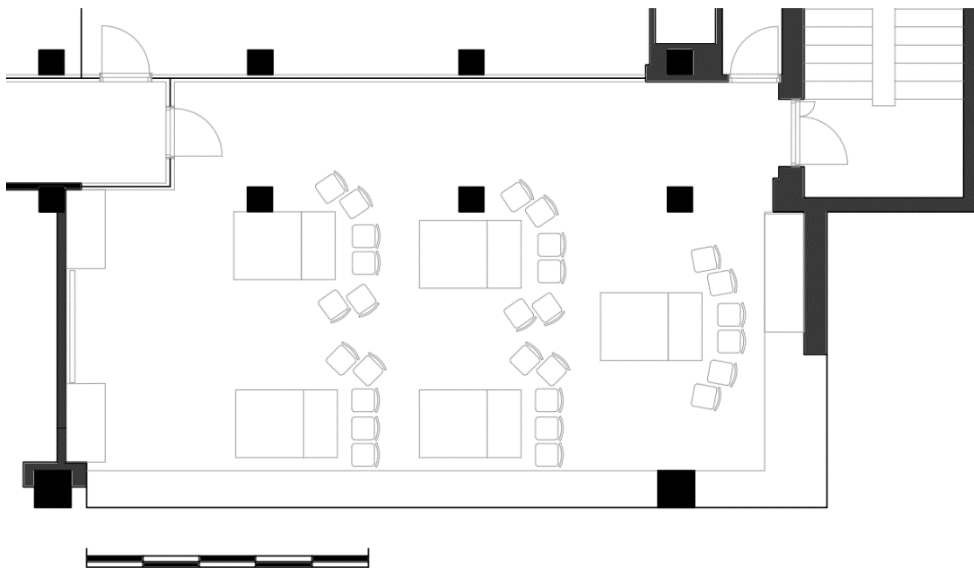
Planimetria del setting d'aula classico di "COMBO"
